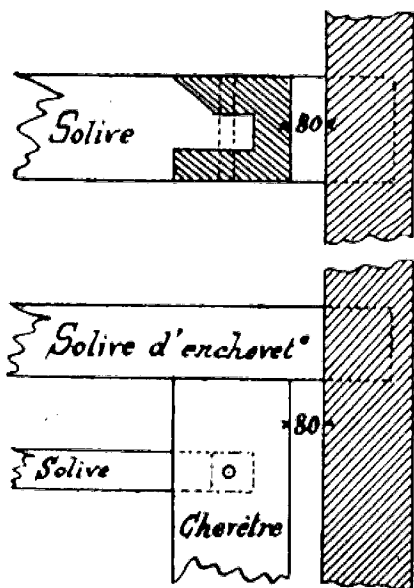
Assemblage des solives courantes avec le chevêtre.
